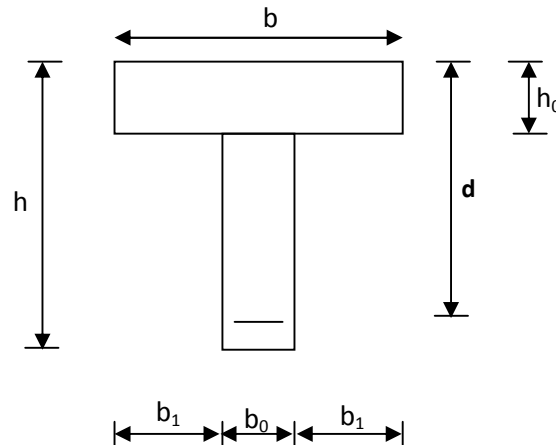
Section de calcul de la poutrelle après Coulage de la dalle de compression aux travées
